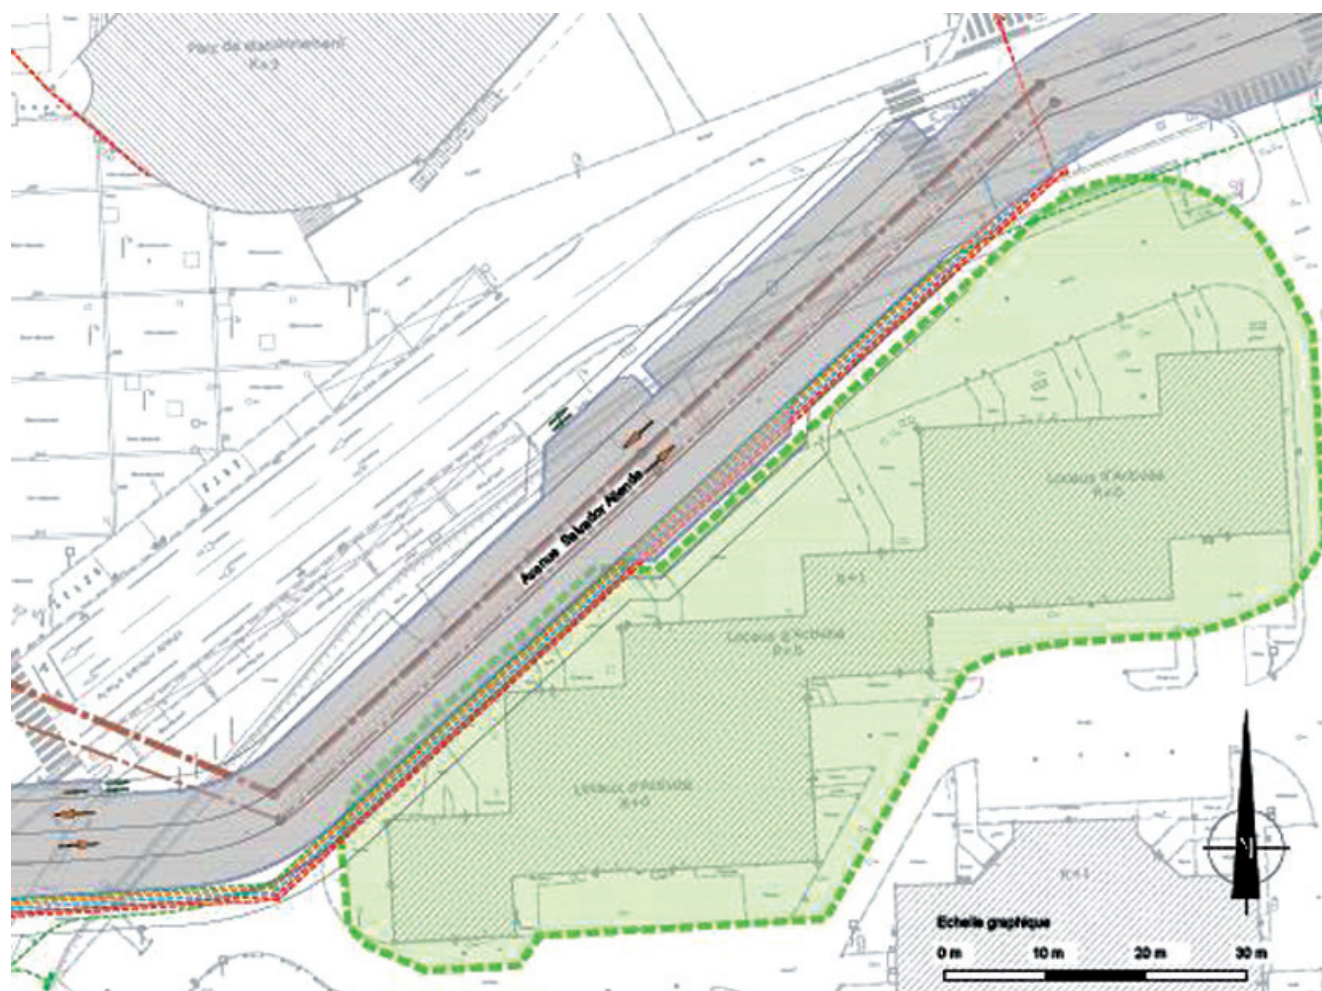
Travaux préalables au sud de l'avenue Salvador Allende
